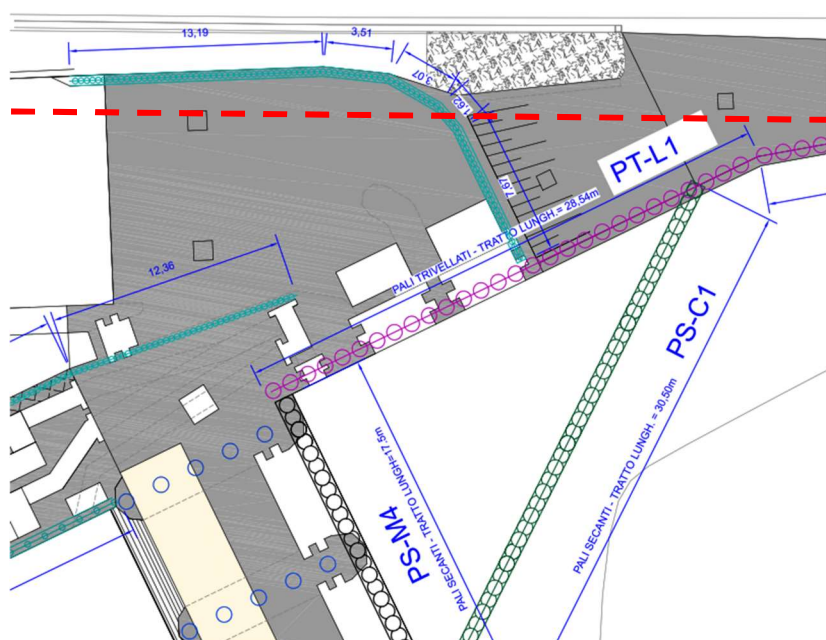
estratto planimetrico di tavola 3.1.1 – in rosso traccia della parte impiantistica Ireti
